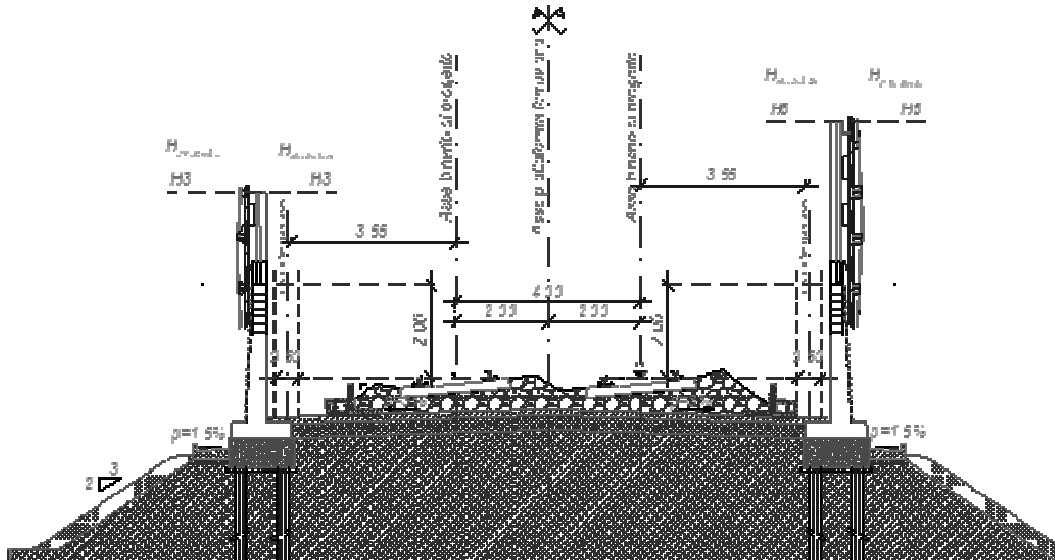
Sezione tipo tipologico BA "HS" rettificato da rilevato
